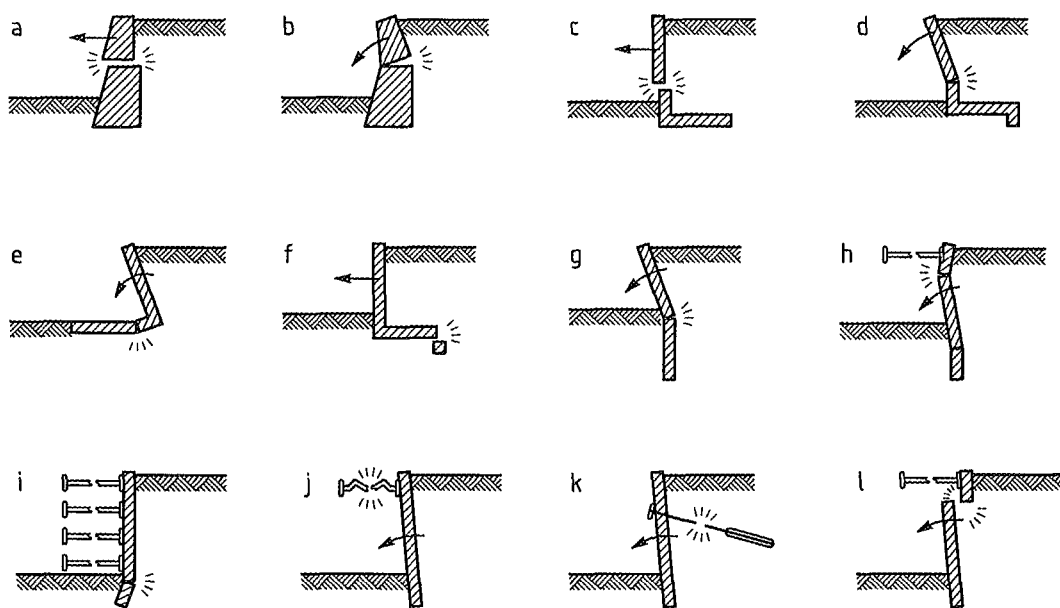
Beispiele für inneres Versagen bei Stützbauwerken
